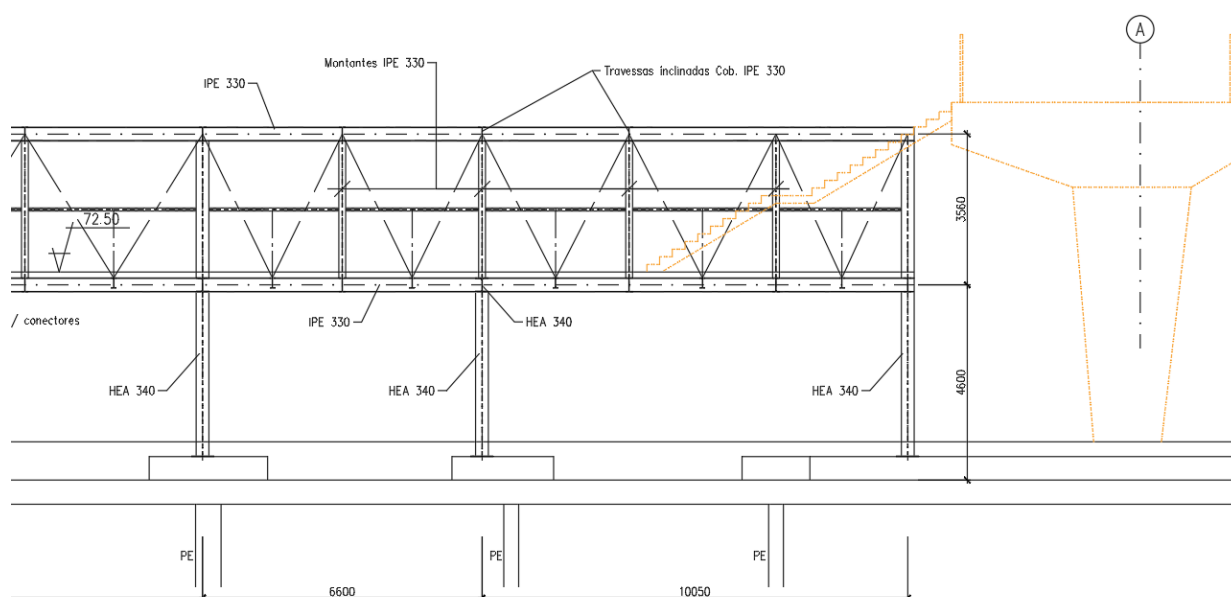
Passadiço de acesso à estação do Metro: Corte longitudinal.
